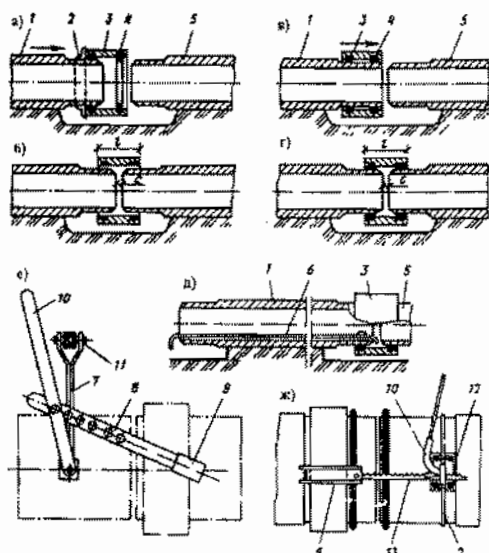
Монтаж асбестоцементных труб на муфтах САМ с резиновыми самоуплотняющимися кольцами: 1 - укладываемая труба; 2 - упорный хомут; 3 - муфта САМ; 4 - резиновое кольцо; 5 - уложенный трубопровод; 6 - переносная штанга; 7 - корпус; 8 - тяга; 9 - захват; 10 - рычаг; 11 - стяжной винт; 12 - упорный башмак; 13 - рейка
